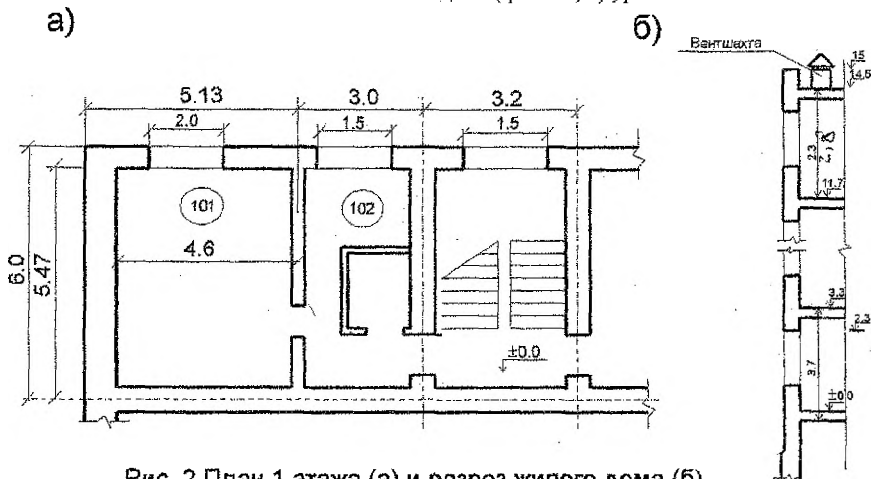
План 1 этажа (а) и разрез жилого дома (б)
